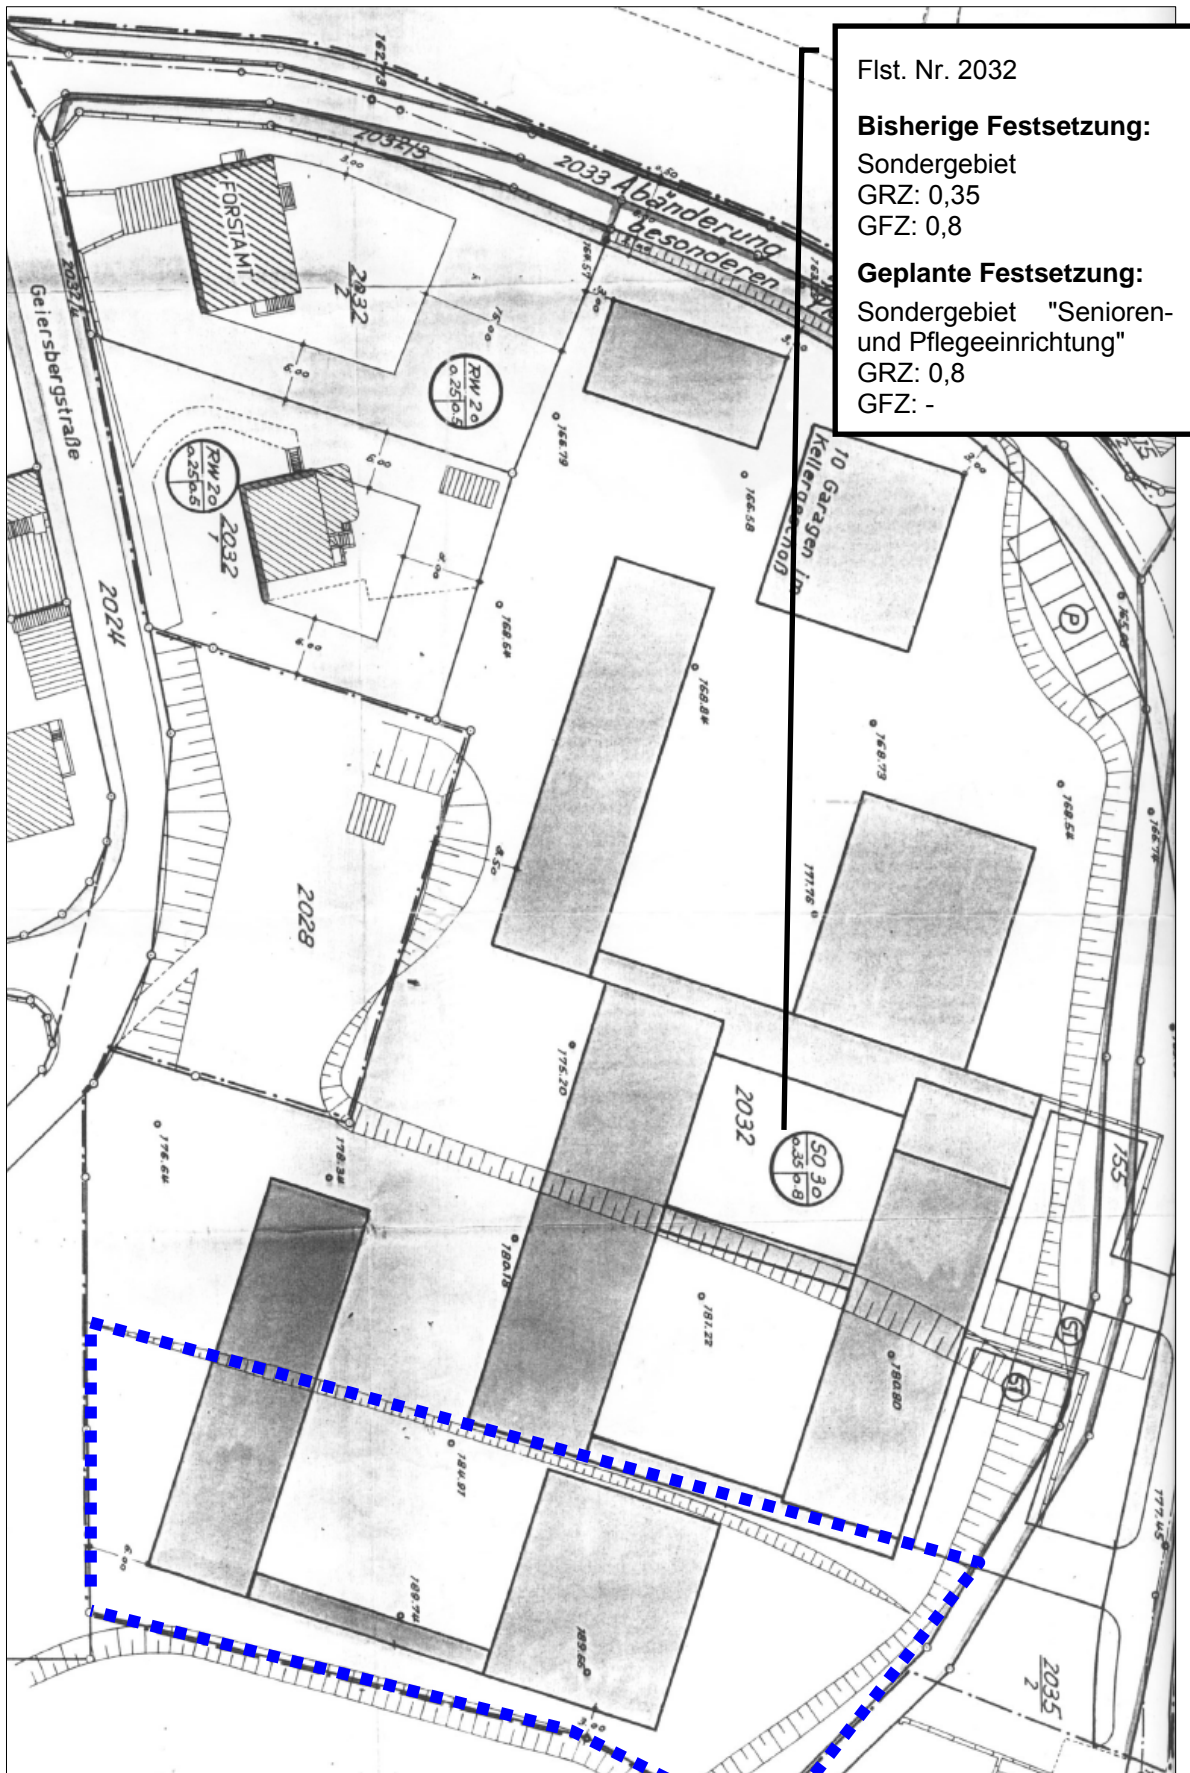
Ausschnitt 1 aus dem B-Plan Nr. 056.A
